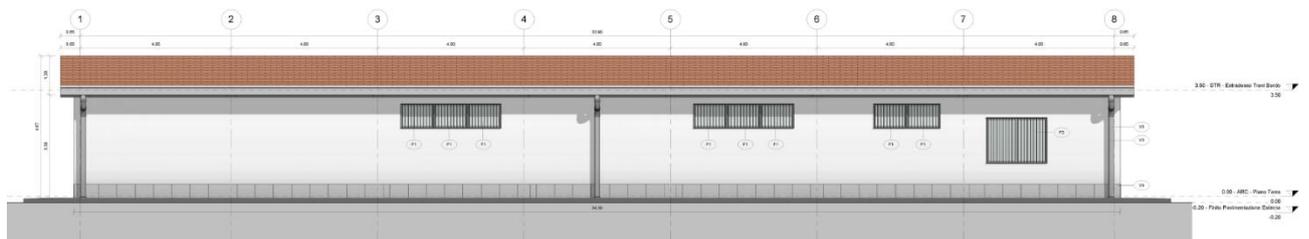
GA Sud Esterno – Prospetto Ovest (Opposto ai Binari)
